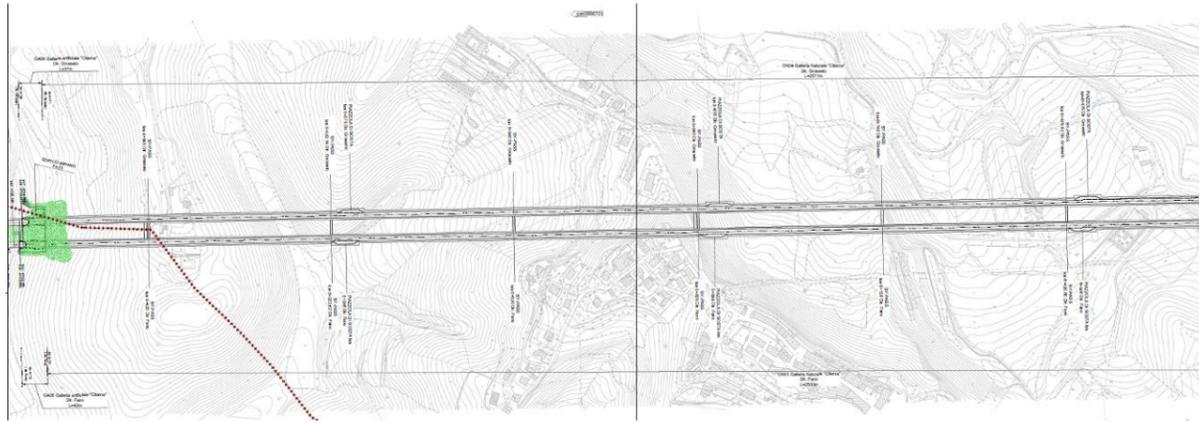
Stralcio planimetrico della galleria "Citerna" – 1° parte
